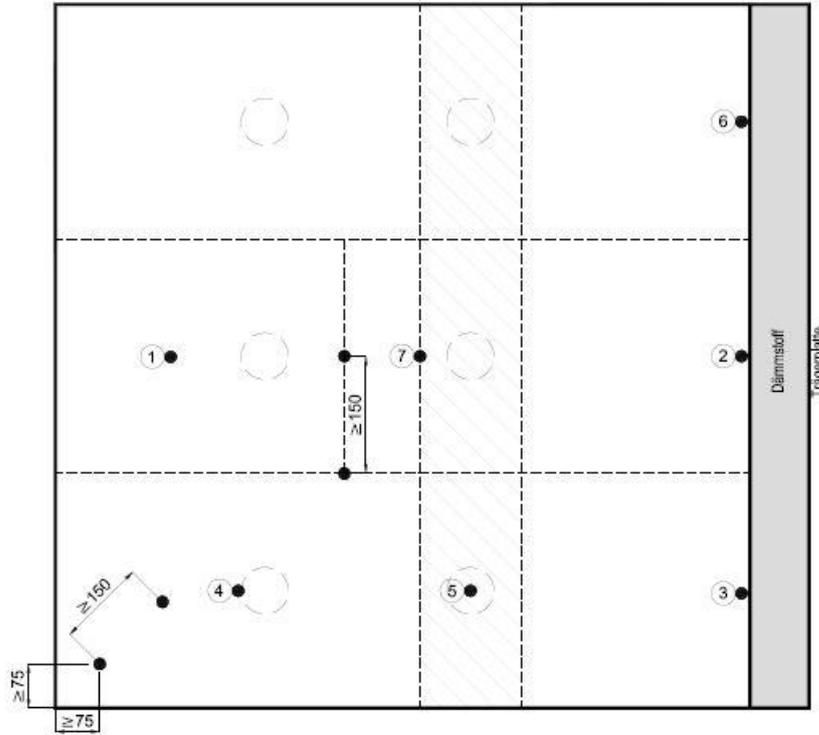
Beschussorte bei Dichtungsbahnen im Grundriss. Probekörperabmessung ca. 1000x1000mm
